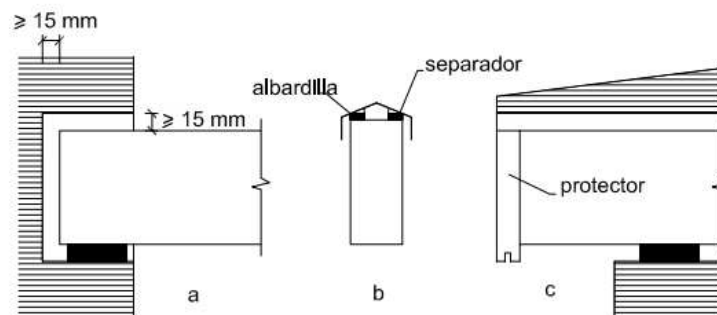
Ejemplos de detalles constructivos de protección de elementos estructurales.
